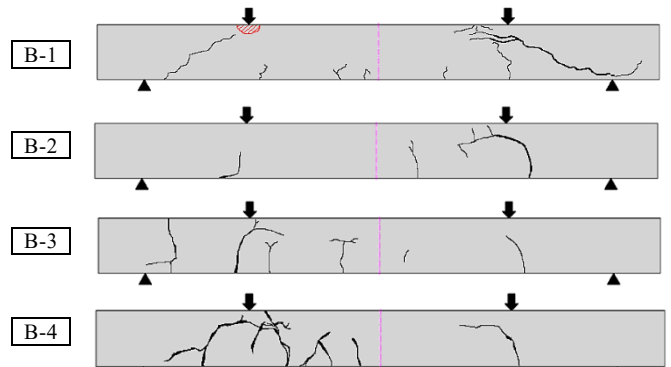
側面のひび割れ図 (B-1~4)
